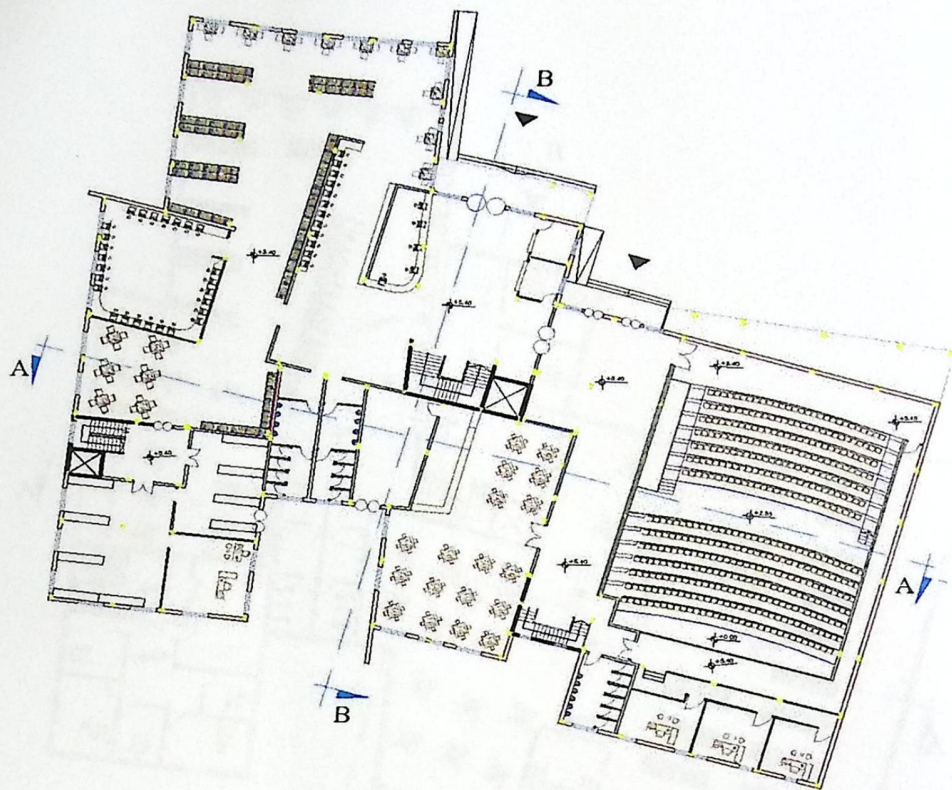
المسقط الأفقي لطابق التسوية .
